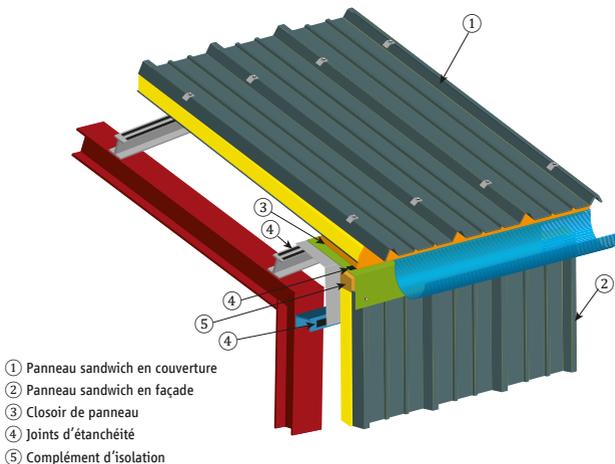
Traitement de la perméabilité à l'air à la jonction entre panneaux sandwichs en façade et en couverture
